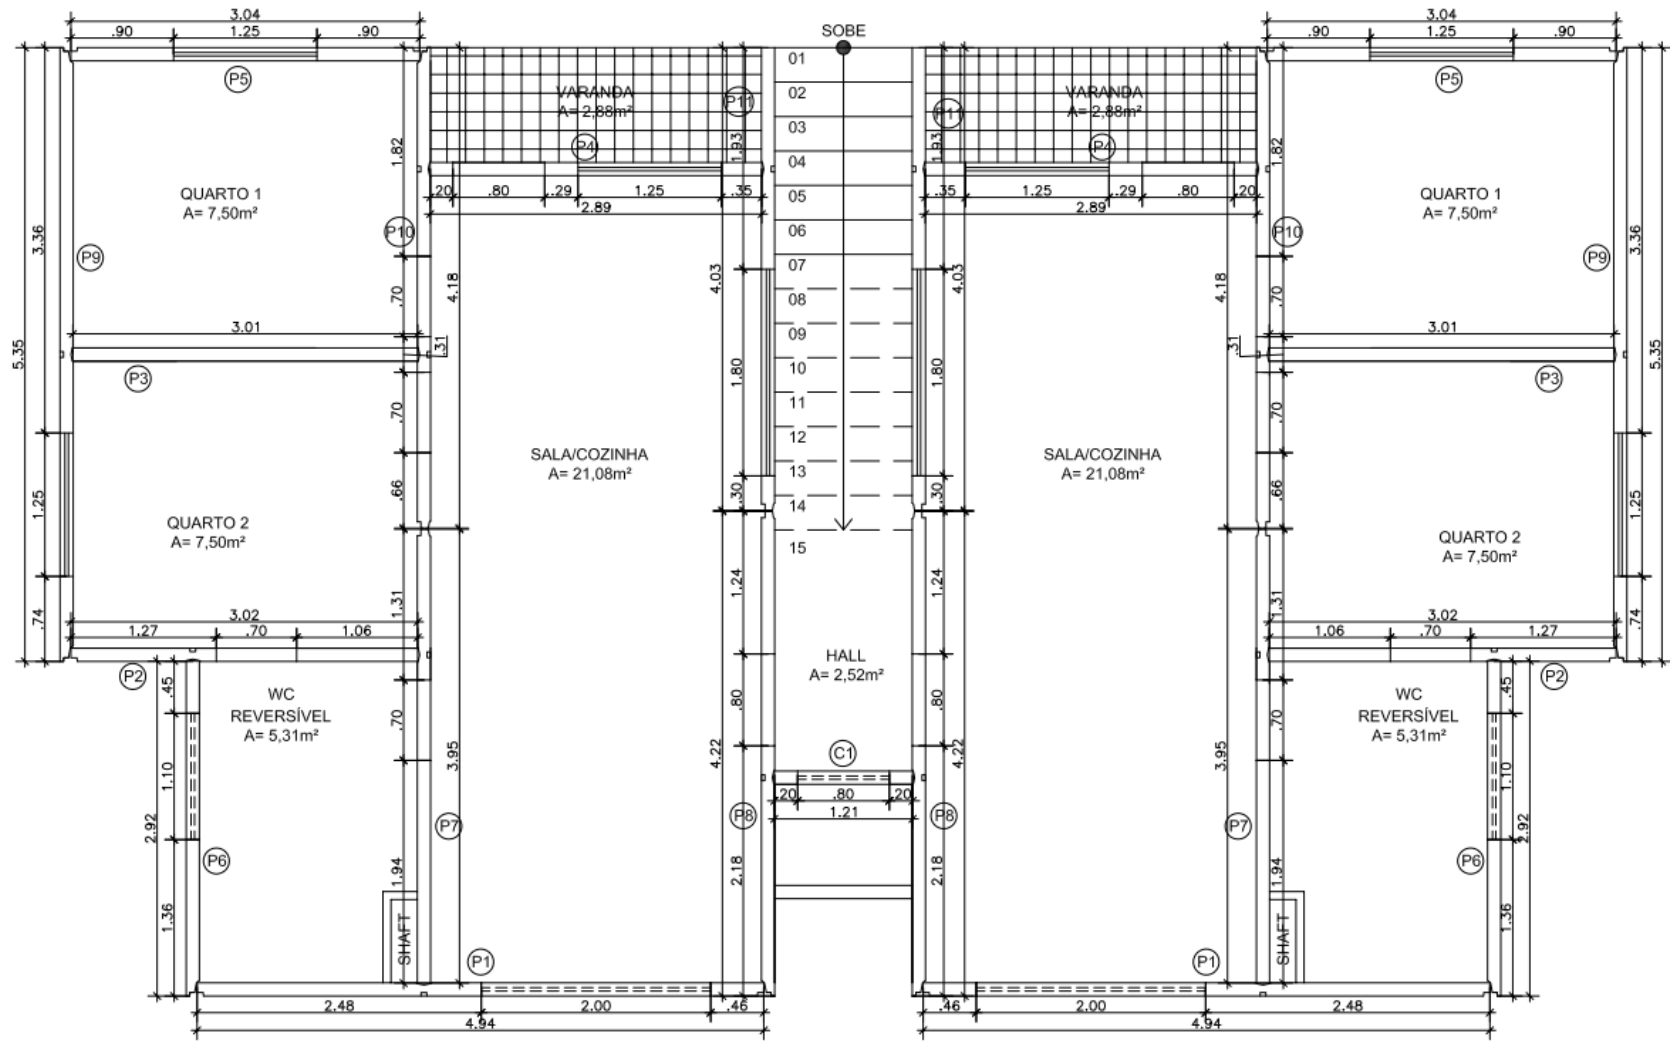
Planta baixa do pavimento térreo da edificação proposta com adaptação ao sistema Olé Casas
